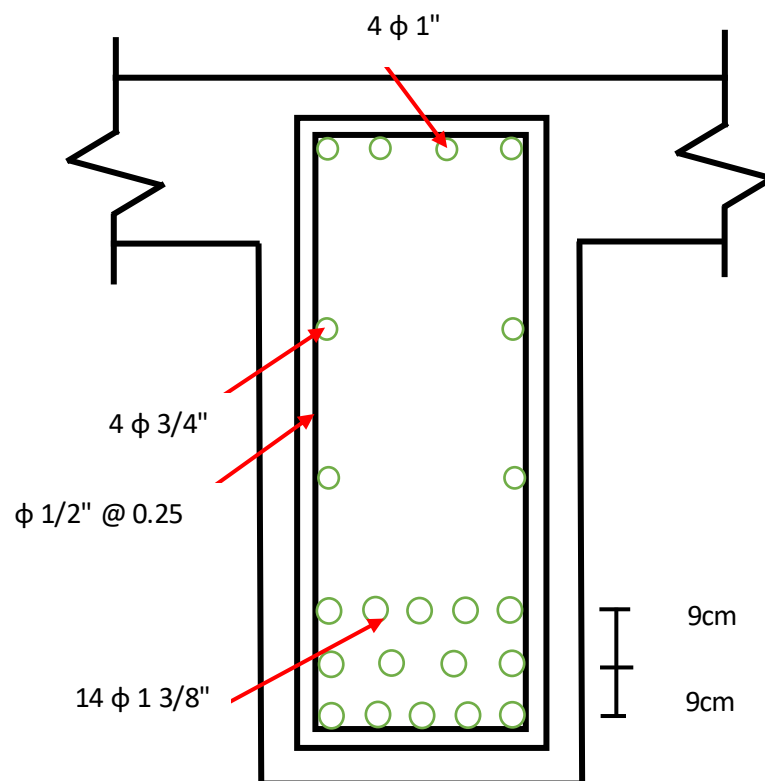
SECCION DE LA VIGA-FUENTE: ELABORACION PROPIA
